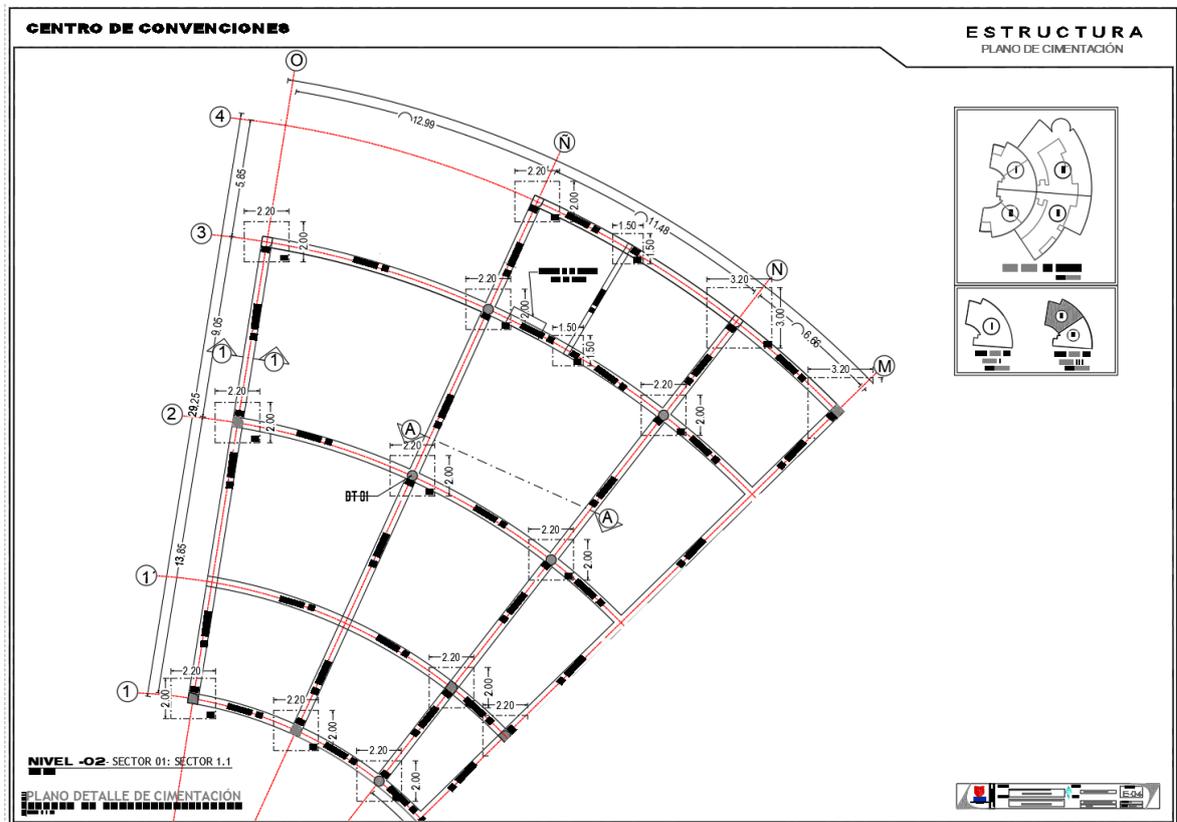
Plano de cimentación a detalle nivel -02 del sector 01: sector 1.1.
